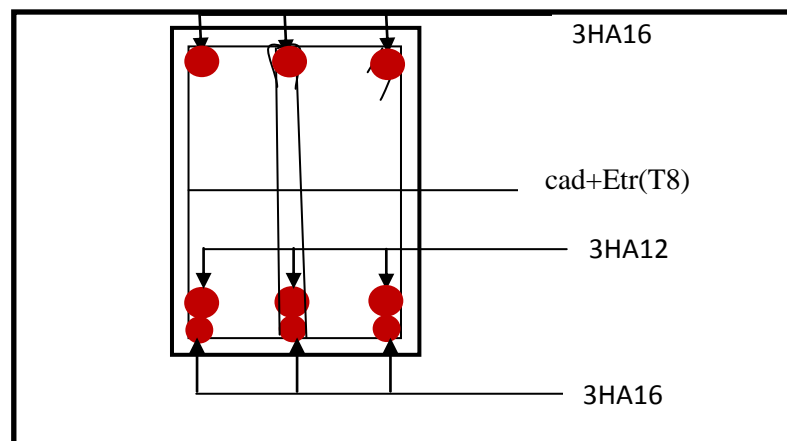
Ferraillage en travée d'une poutre principale
